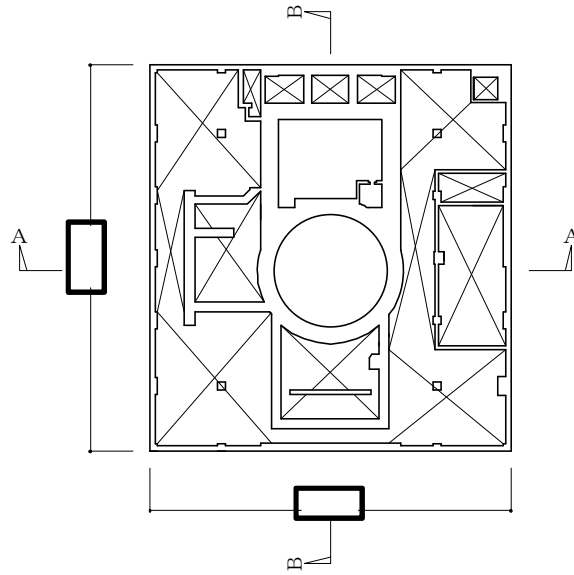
(7/9)  の概略平面図 (EL. 34.7 m)
